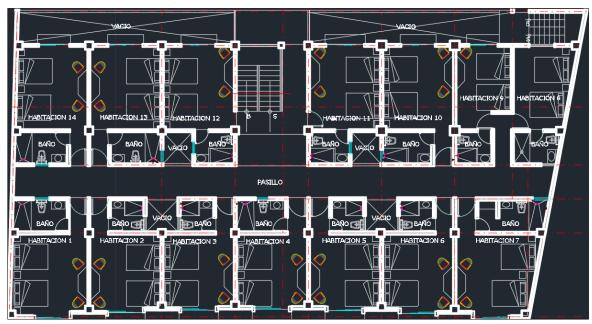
Planta arquitectónica del Primer nivel del proyecto.
